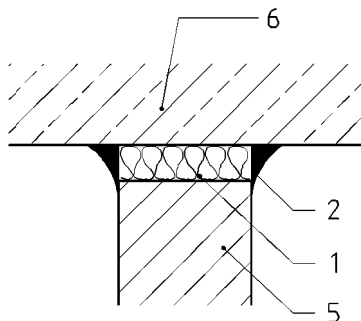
Junta de dilatación entre un muro (pilar) y un muro de hormigón
